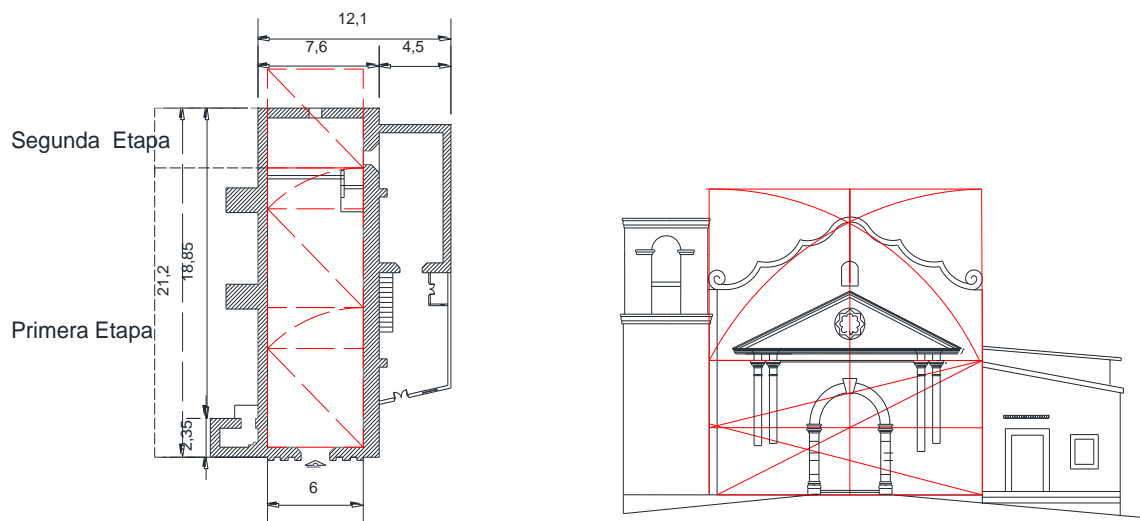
Trazo de la planta arquitectónica con el rectángulo dinámico, realizo J. O. B. G.
